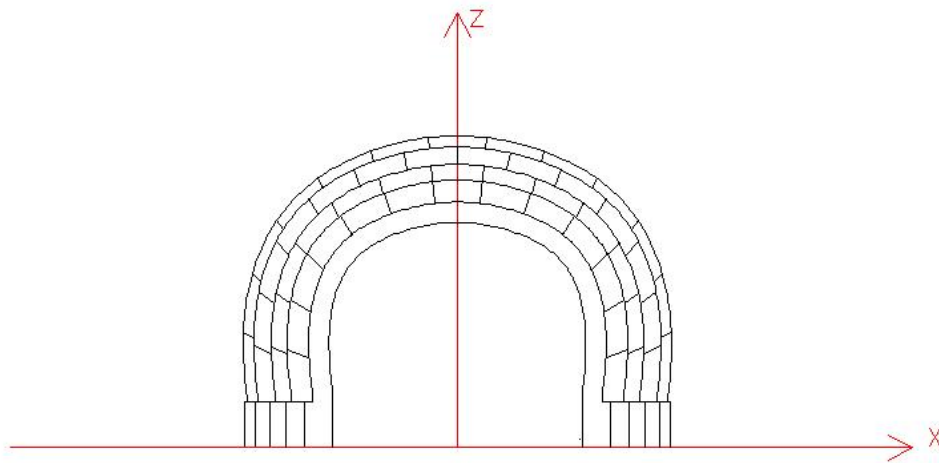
5 Sezione strutturale corretta in AutoCAD
